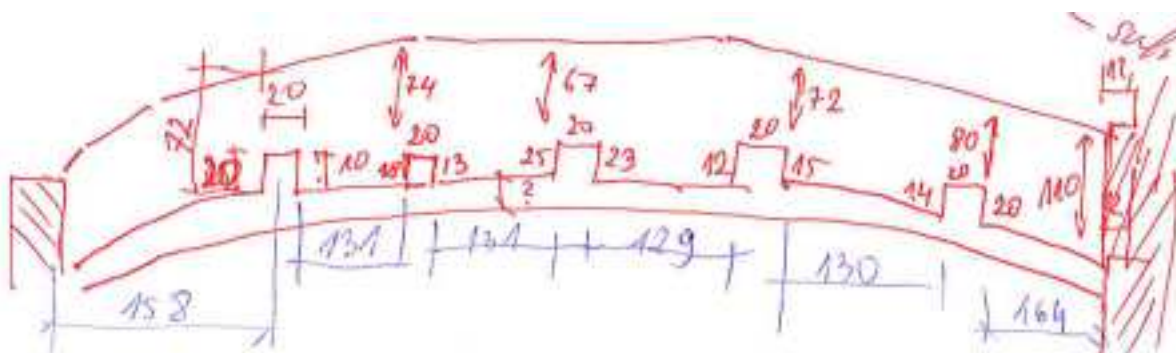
Pomiar szerokości żelbetowej belki łukowej nad „Salą na Piętrze”
